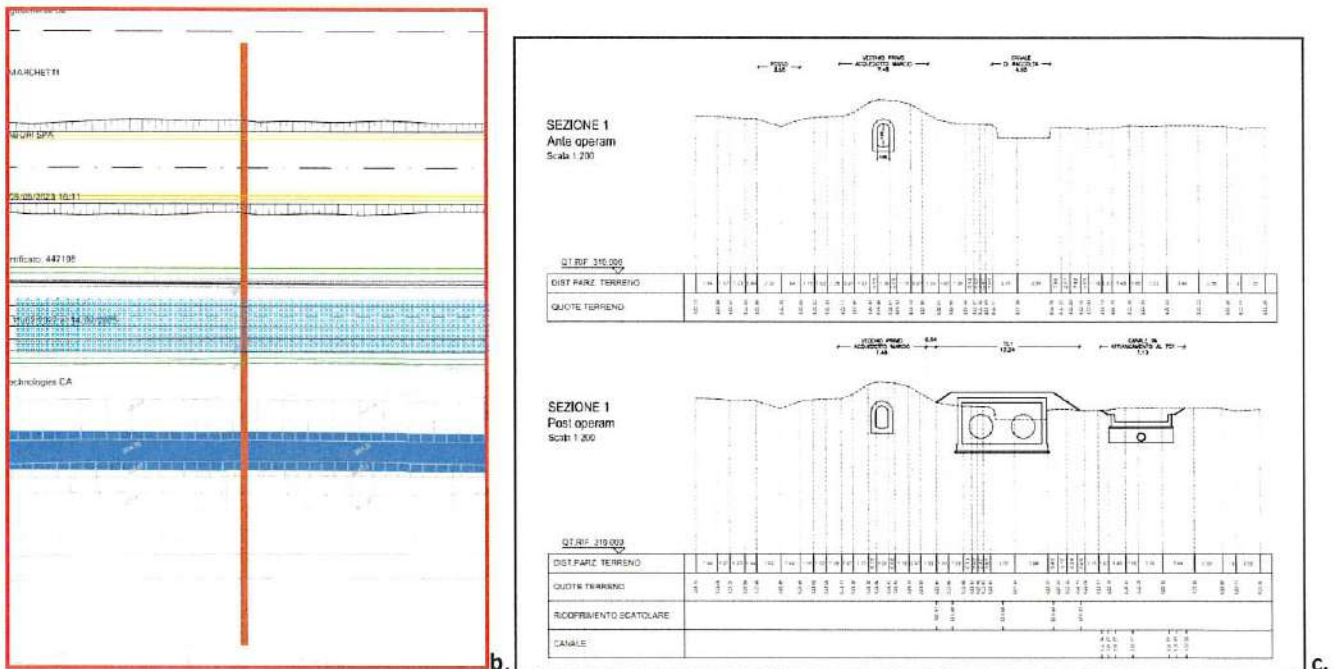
b e c Allegato 2 – planimetria e sezioni di dettaglio tratto TC1 – Ante e post operam (estratto elaborato A250 SIA R016 0)
